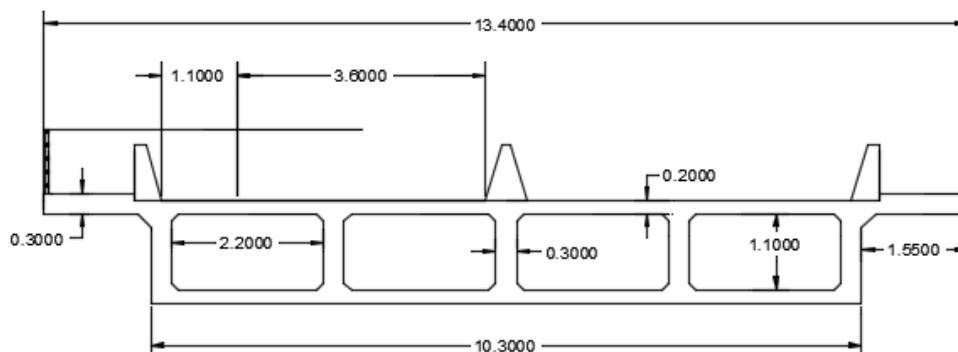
Sección tipo de la Superestructura de los puentes (Fuente: elaboración propia)
